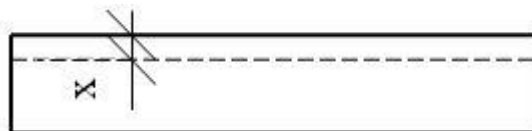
Расчётная схема сжатой зоны высотой  $x$  в сечении монолитной сплошной плиты перекрытия.
